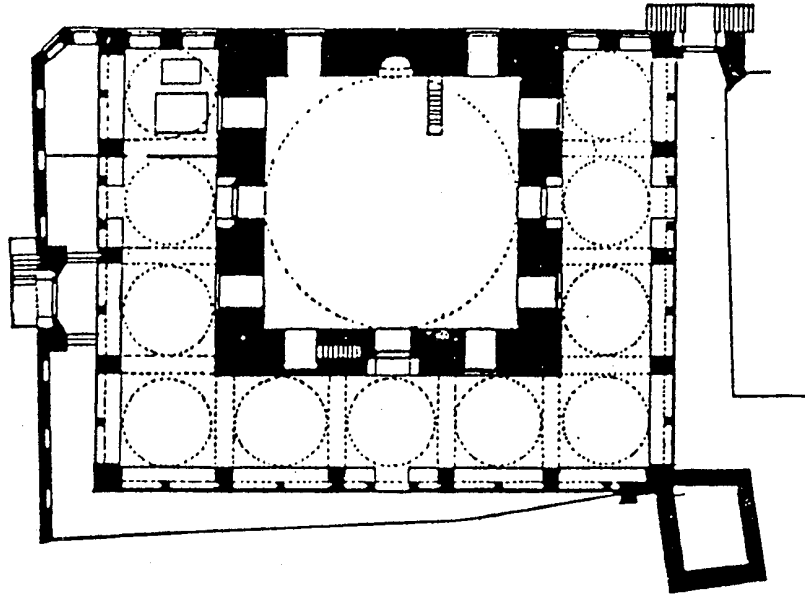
مسقط أفقي لجامع بئرل في اجرا (عن : hoag)
